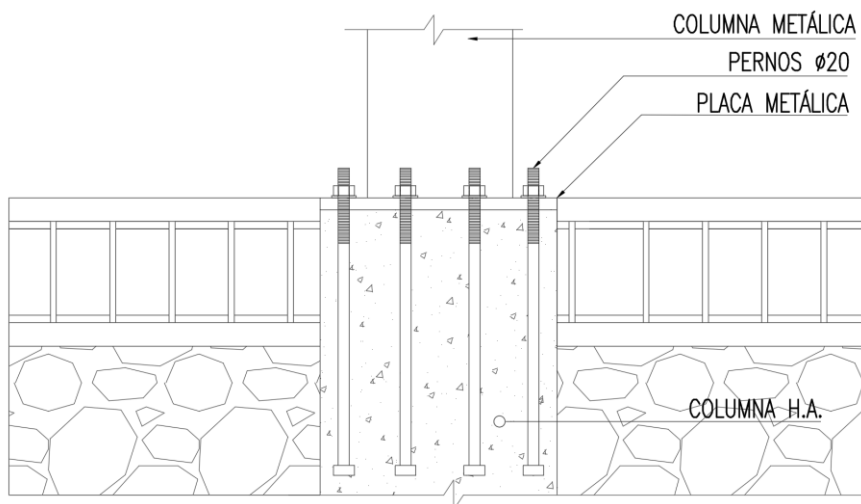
Ejemplo de detallamiento de pernos de anclaje.
